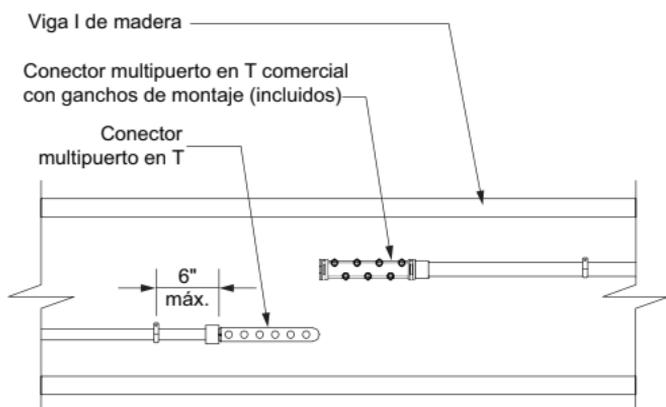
Apoyando a conectores multipuerto en T en vigas I de madera
